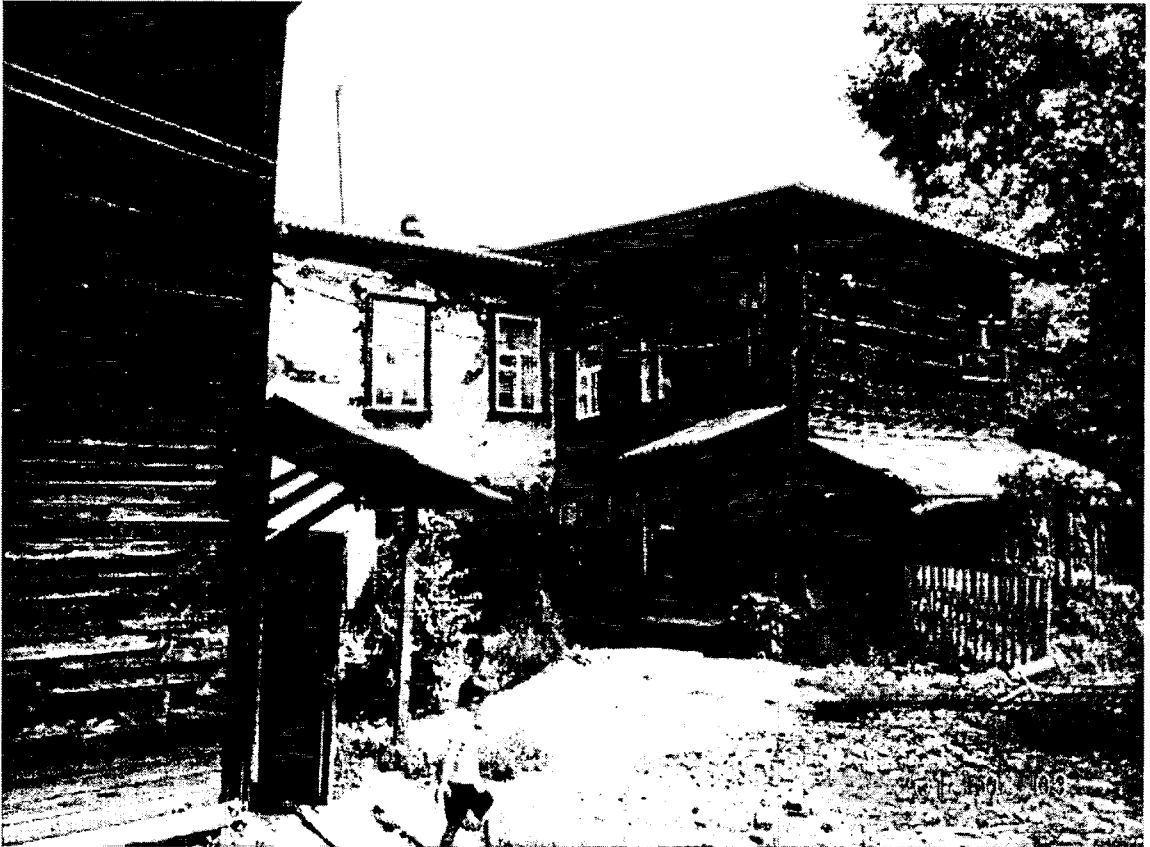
Фрагментарное раскрытие дворового юго-западного фасада. Дворовая территория
